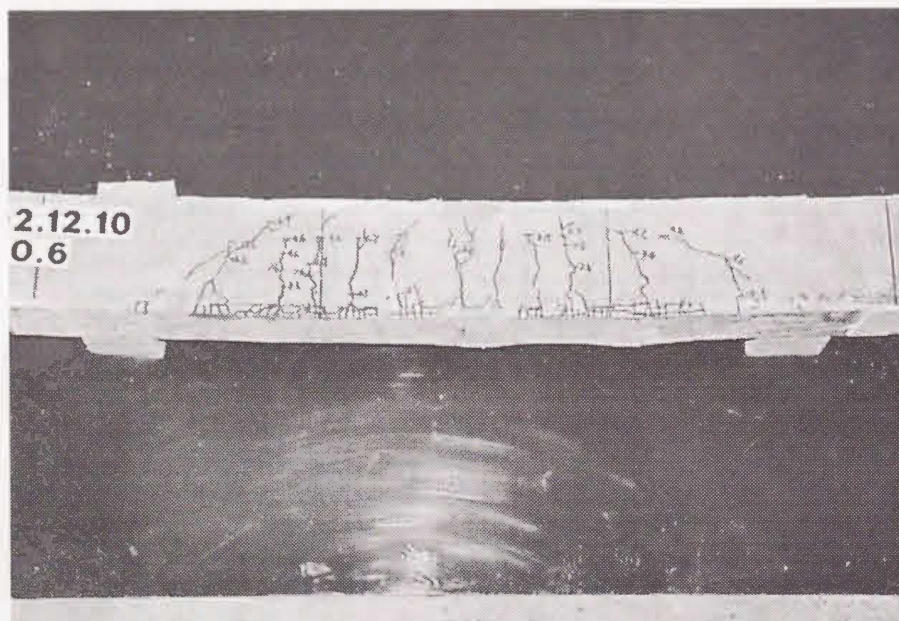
2 鉄筋コンクリートはりのひびわれ状況の一例
